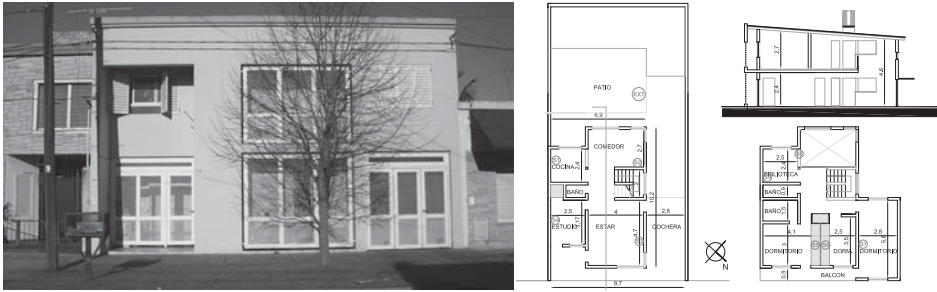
Fachada noroeste de la vivienda (Foto 07-2008).
